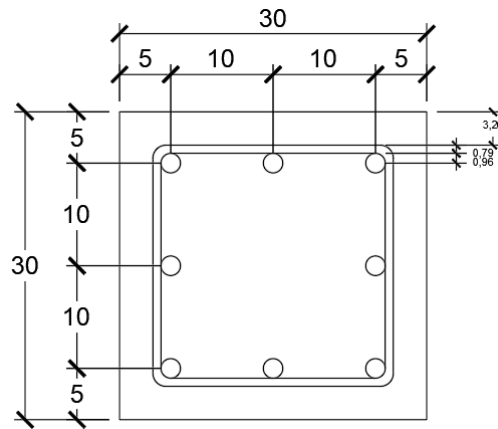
Detalle del armado de columnas para el modelo 1, cotas en centímetros
